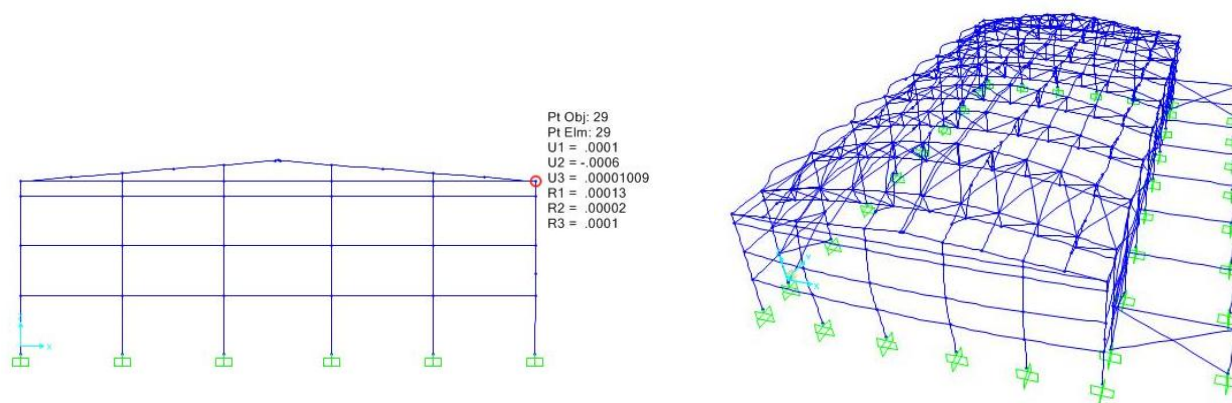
Deformada de la estructura bajo la acción del viento Vy2 (SAP2000).
